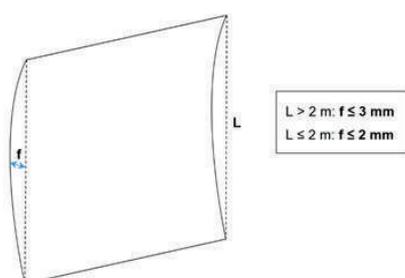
Tolerancias de montaje del precerco: planimetría.
